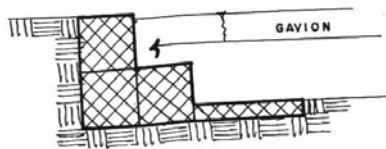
Elevar nivel del muro (fuente: Grupo CALSA)
